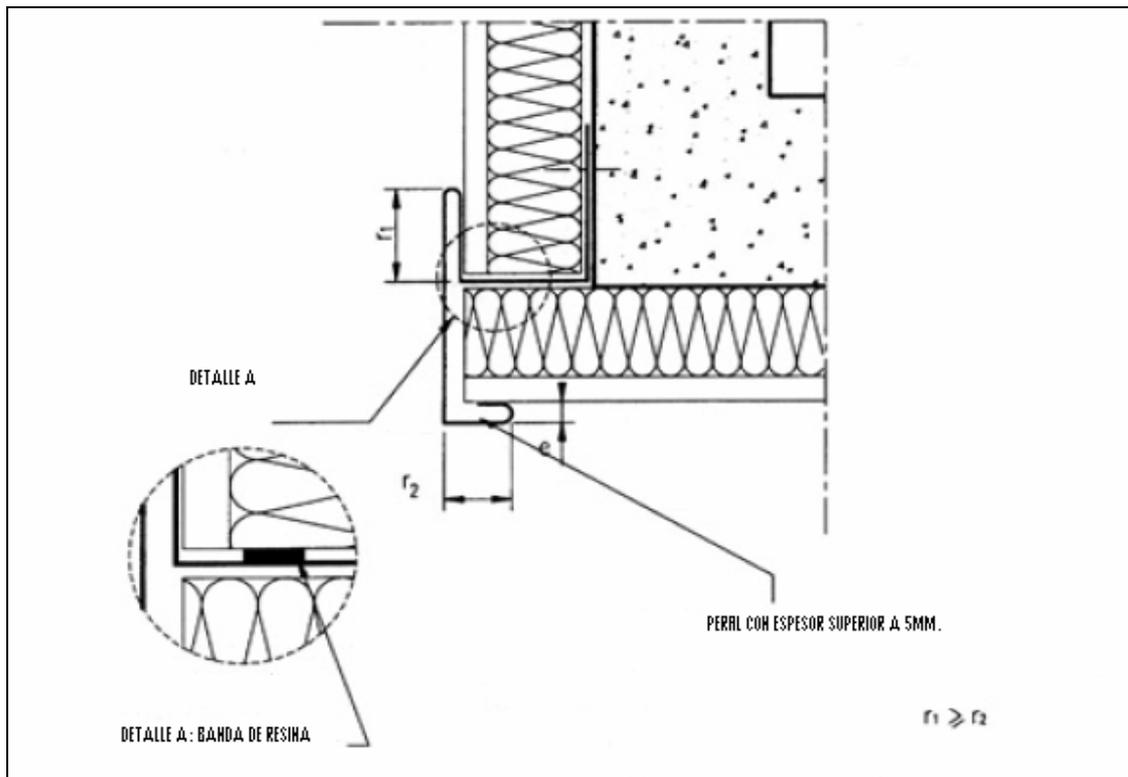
Detalle de solución, para paneles prefabricados adosados a muros esquina.
